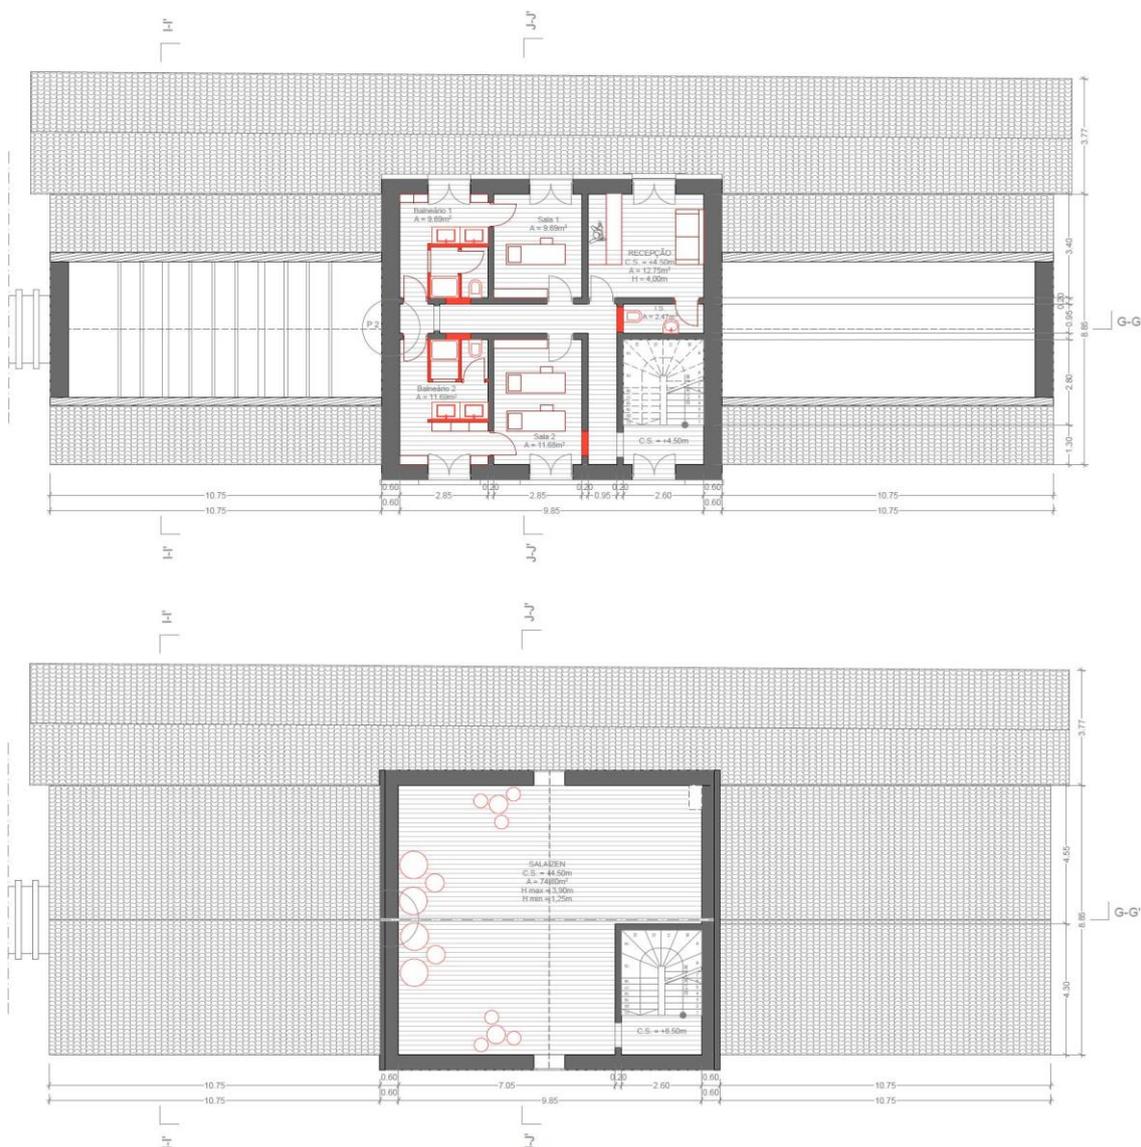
e 108 \_ Plantas do piso 1 e 2 da proposta, respectivamente.
